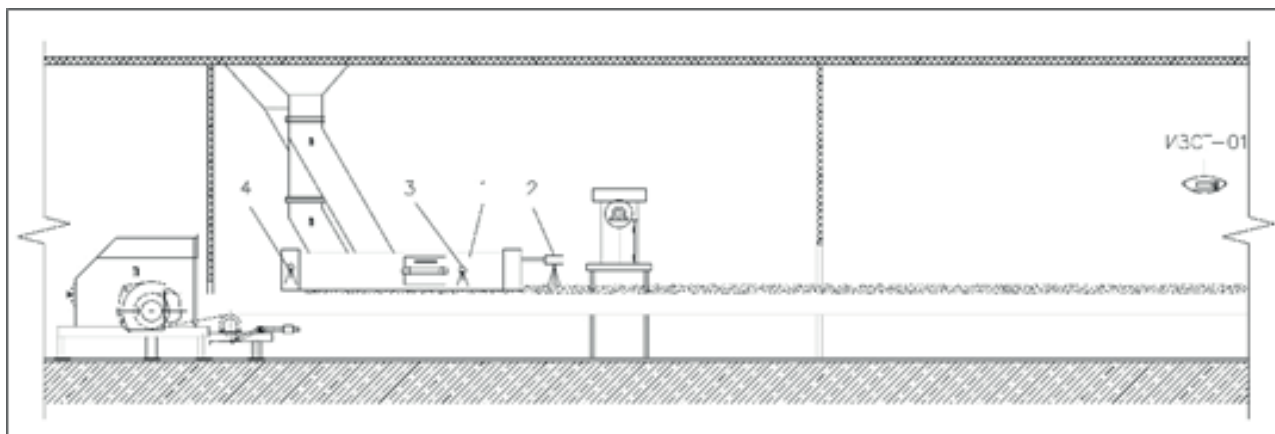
Технологическая схема размещения оросителей установки пылеподавления УП: 1 – Короб; 2- Туманообразователь ФСТ-90; 3,4 - форсунка КФ-5х75
